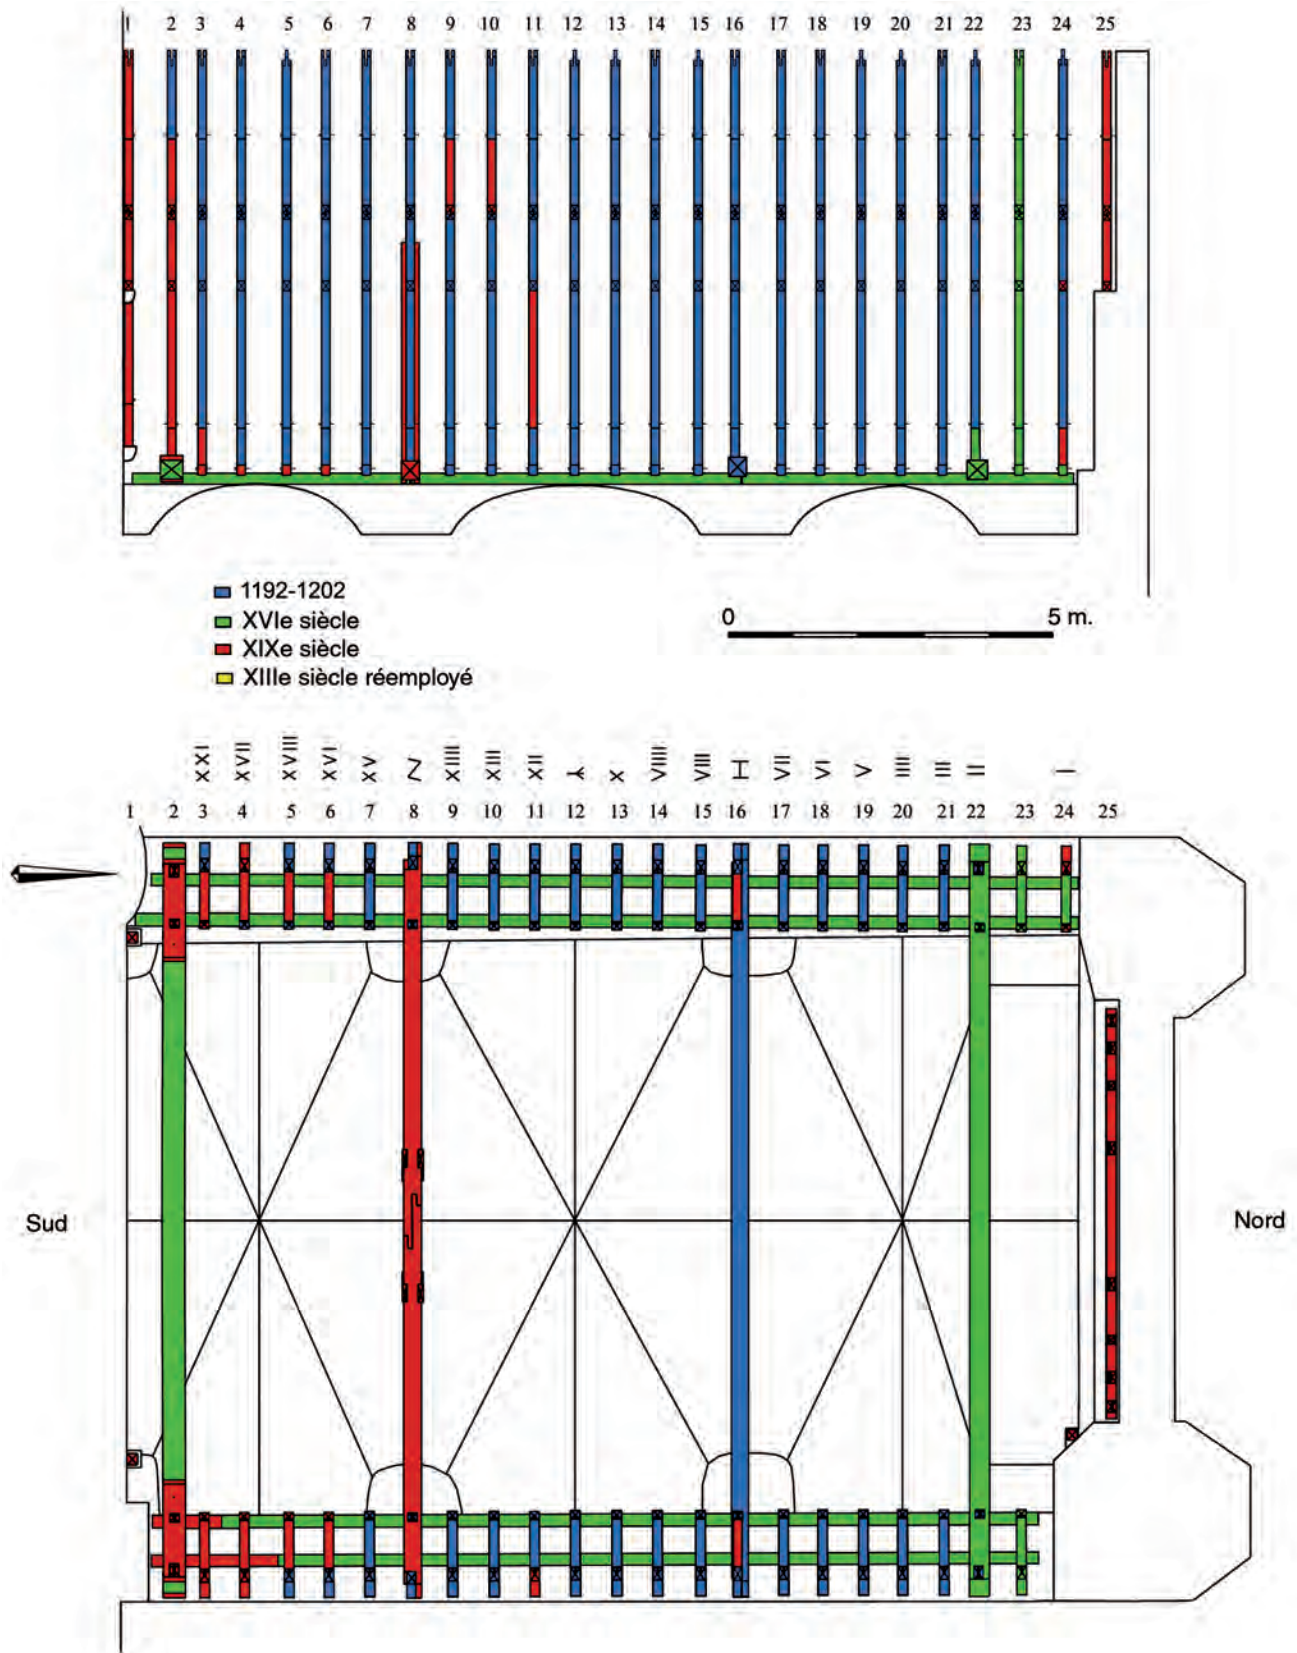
Charpente du croisillon nord (1192-1202d) : coupe longitudinale sud-nord et plan au niveau des entrails.
